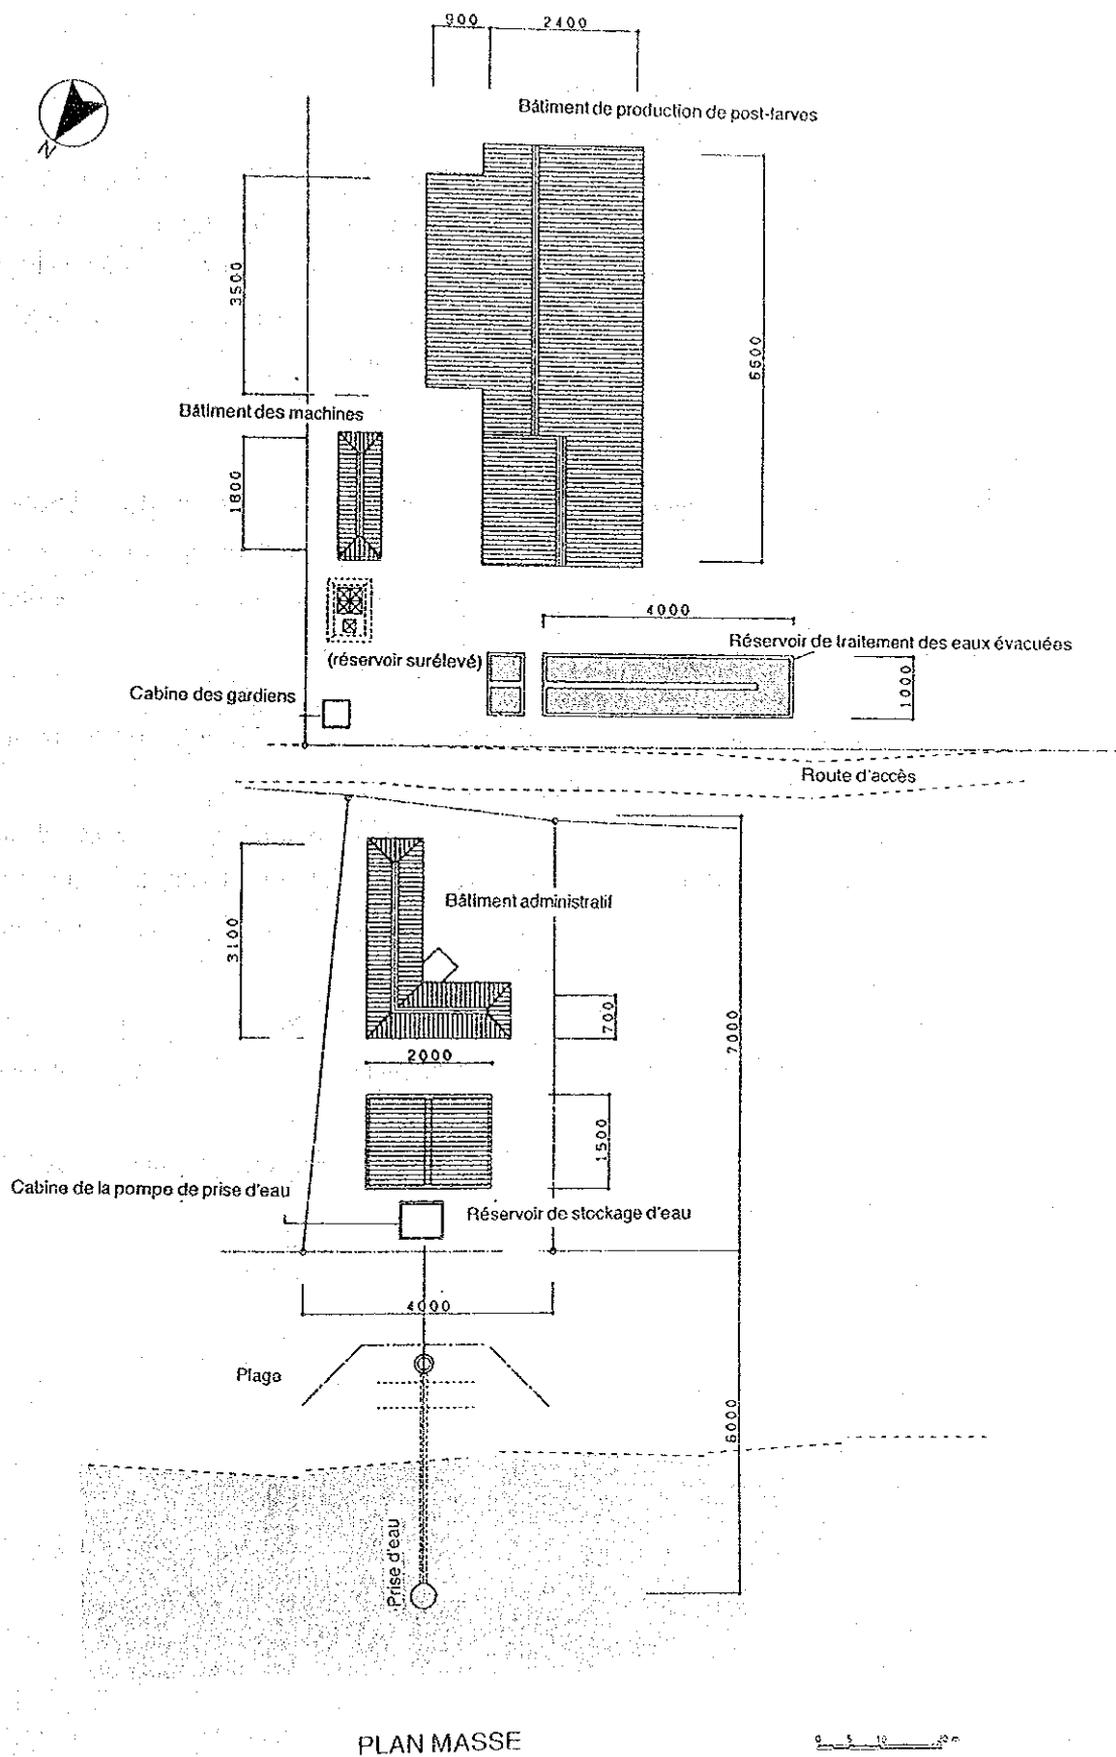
Plan d'implantation des installations du centre de production de post-larves
